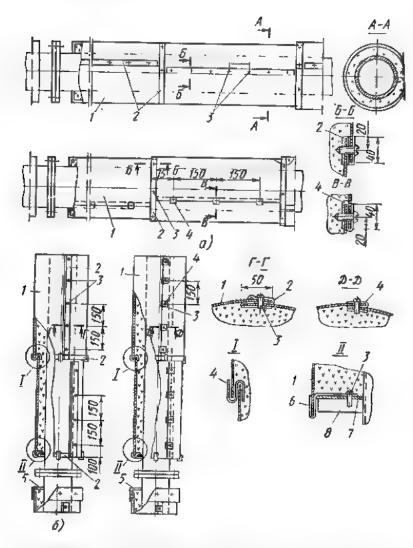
Покрытия изоляции упругими оболочками горизонтальны (a) и вертикальных (б) трубопроводов.
